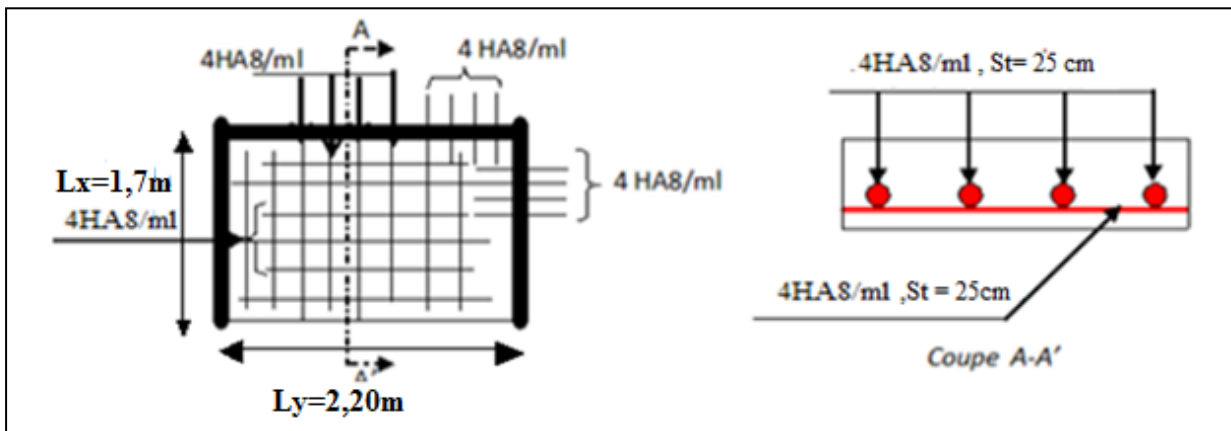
Schéma de ferrailage de la dalle sur 3 appuis.
